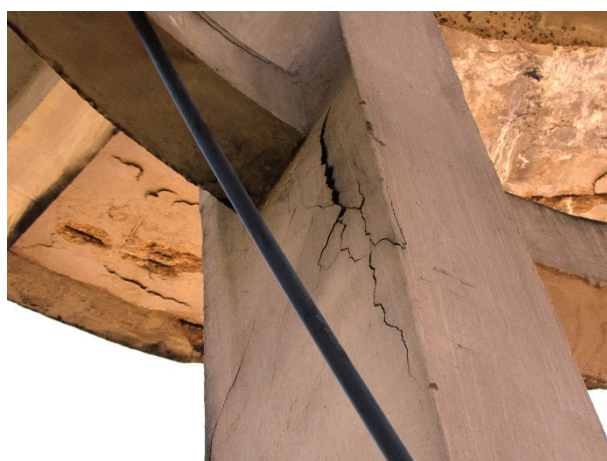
Detalhe de pilar no 2º lance com incidência de rachaduras nas adjacências da viga
